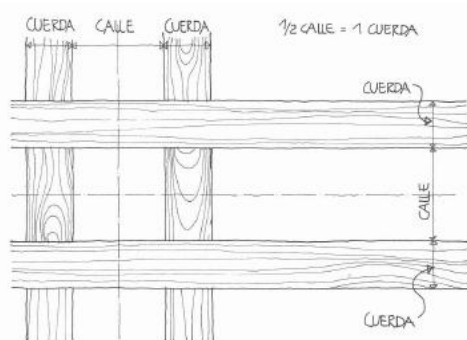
Afastamento praticado entre as vigas [Matauco, 2000].
